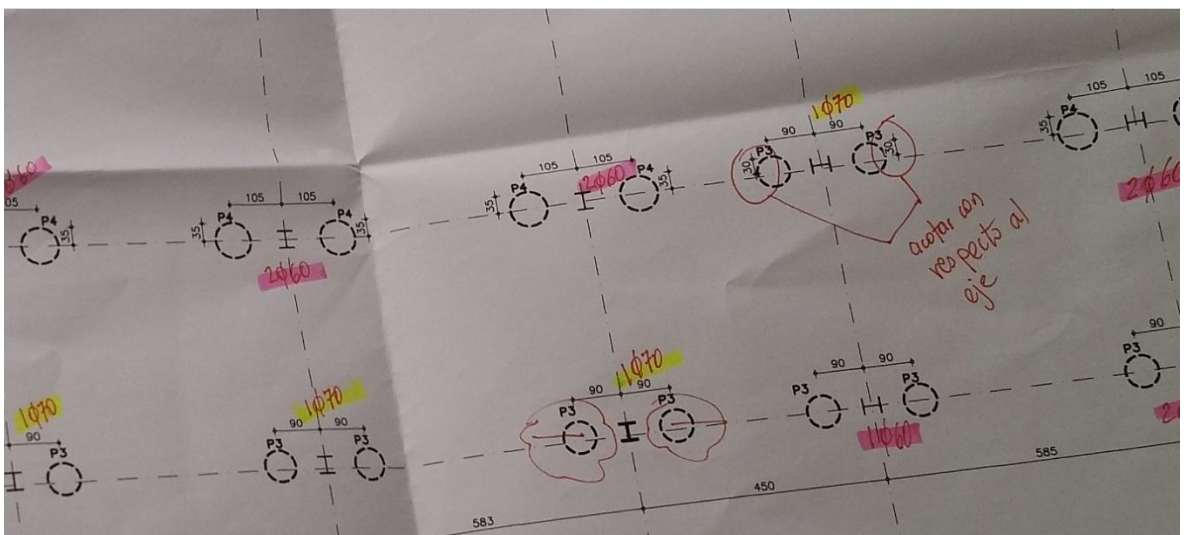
PLANTEAMIENTO FINAL PLANTA DE PILOTES.
